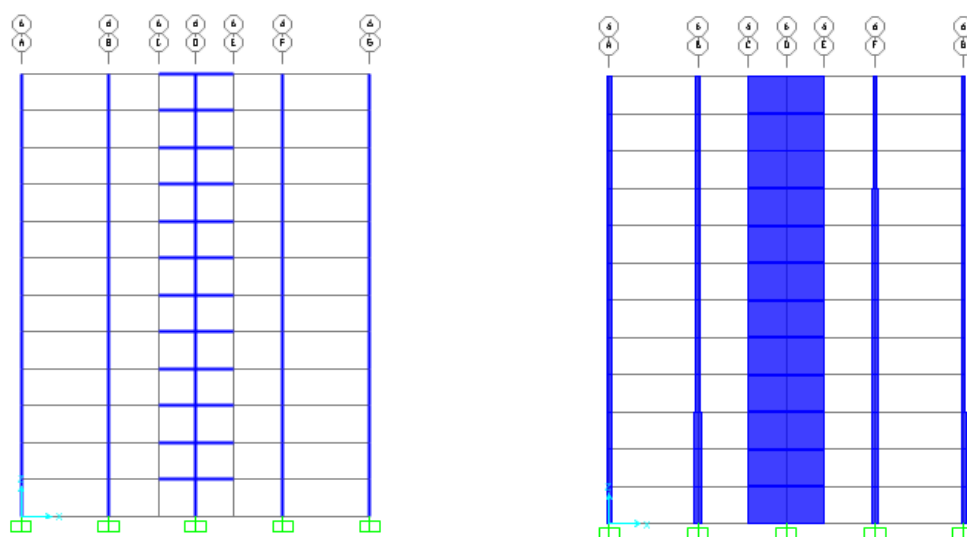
Pormenorização da barra de ligação ao longo de toda a parede
